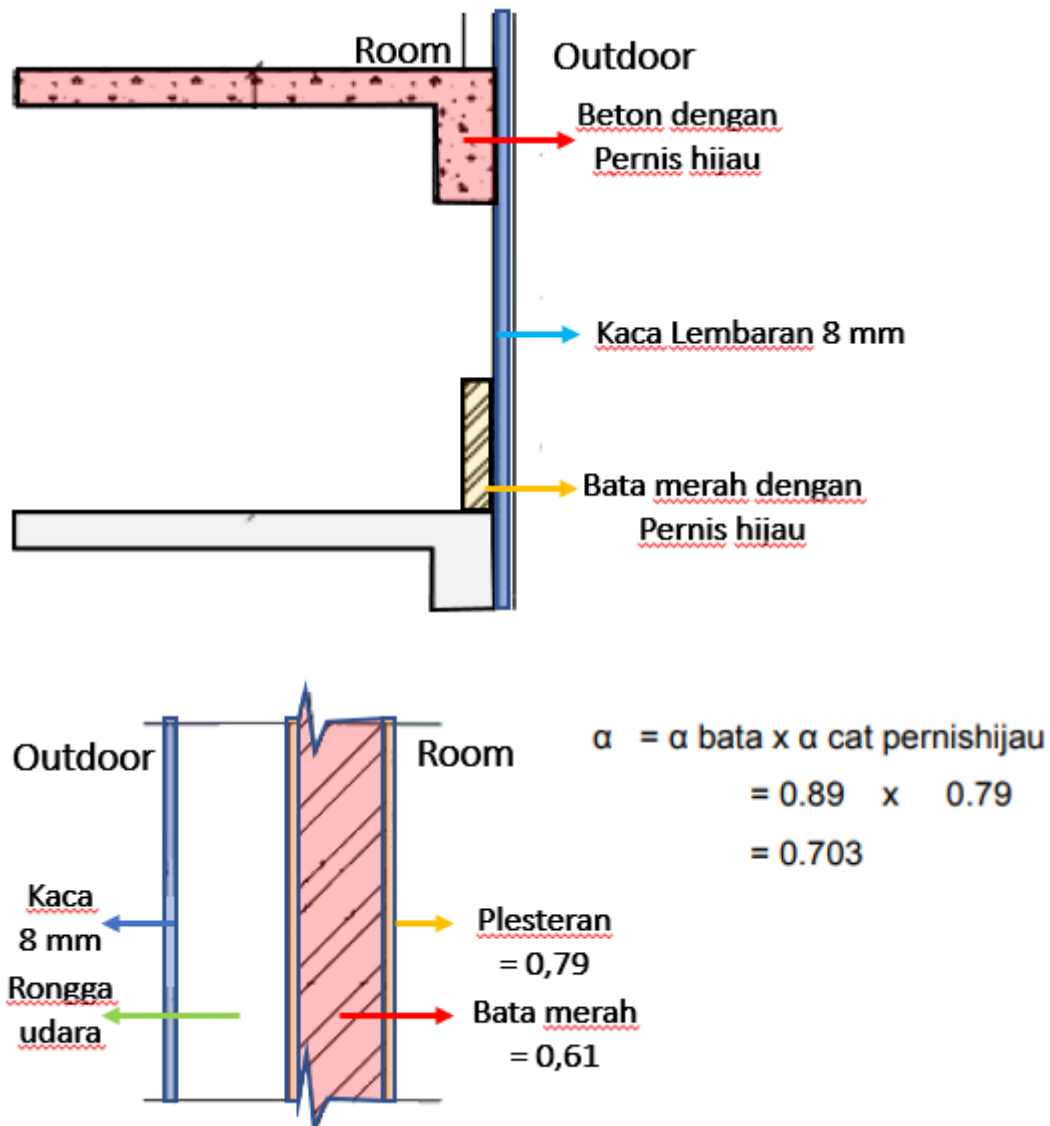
8 Nilai Dinding Beton pada Bangunan
